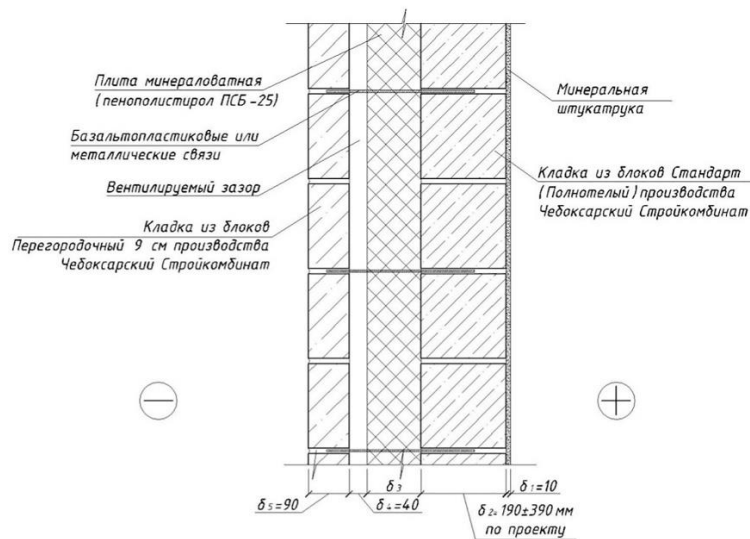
Слой наружной стены с облицовкой из кирпича
